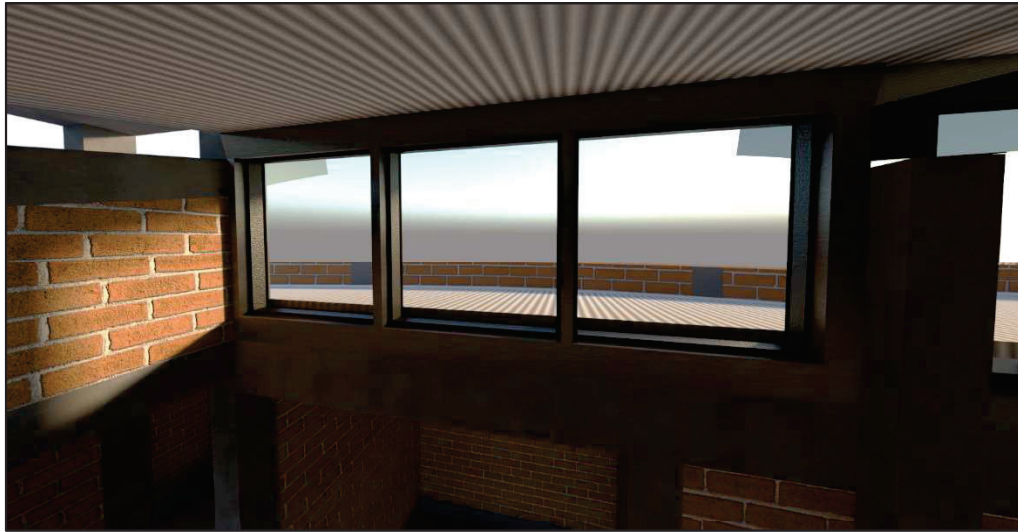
Propuesta de tragaluz como cerramiento vertical entre viga y cubierta.
